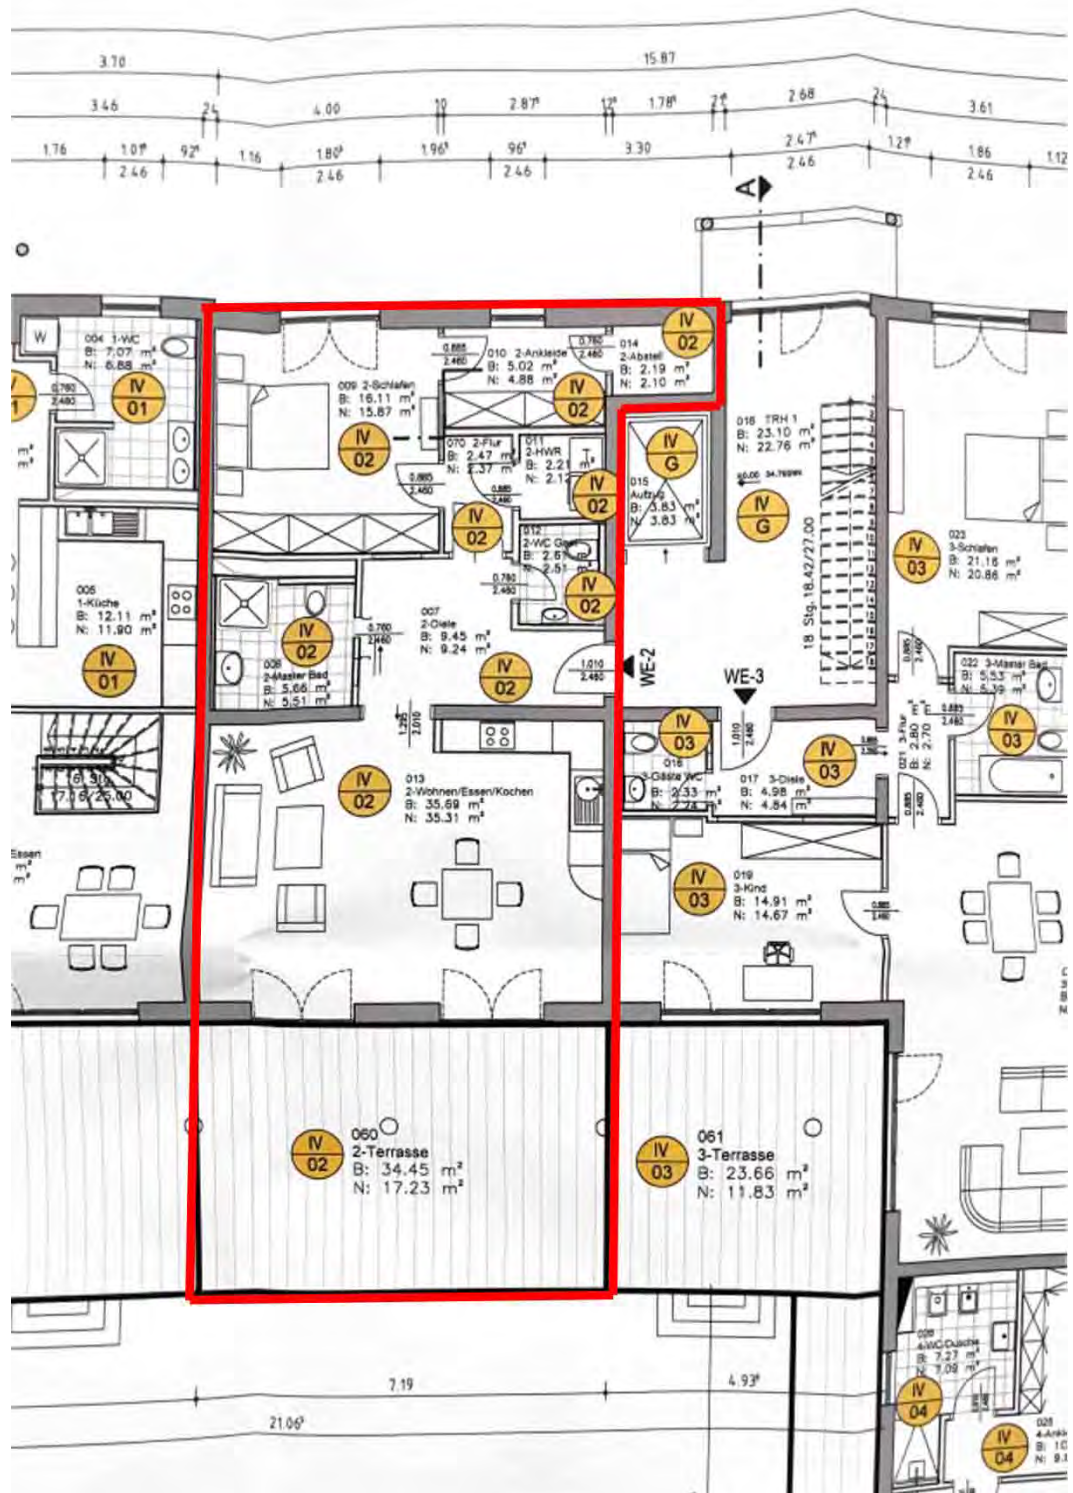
Grundriss lt. Aufteilungsplan Wohnung Nr. IV/2
